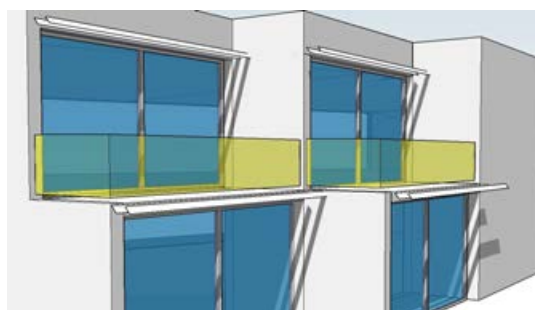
Autre solution : Baies situées sur une même façade mais sur des plans décalés
